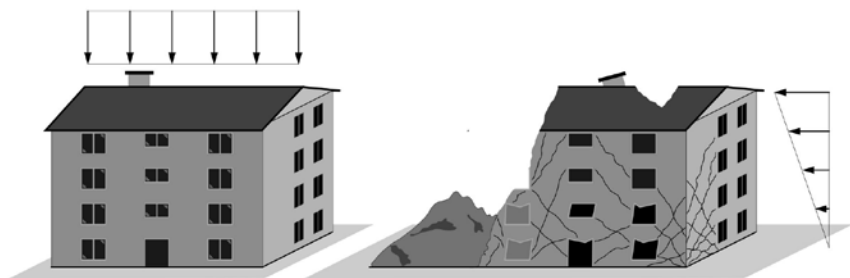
Erdbeben sind für Bauwerke gefährlich, weil sie sehr großen horizontalen Druck ausüben. (Lestuzzi, P.: Séismes et Construction. Eléments pour non-spécialistes. Lausanne, 2008)
